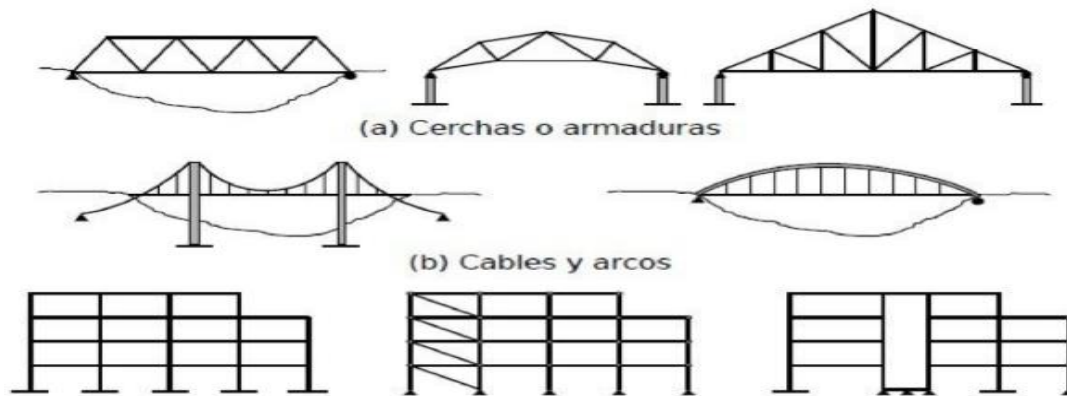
Estructuras retículas sometidos a esfuerzos de tensión, compresión, flexo-tensión.
